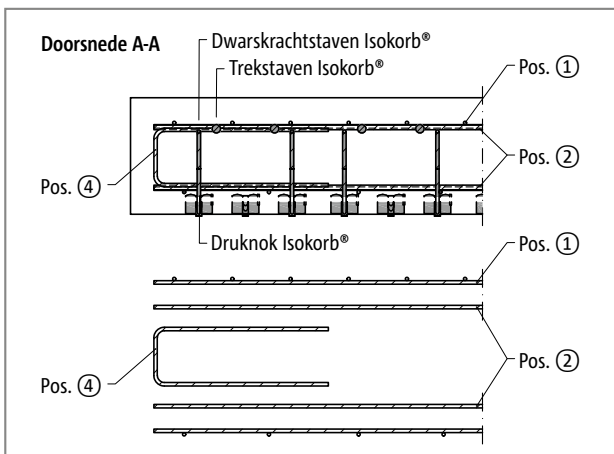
Schöck Isokorb® CXT type K-E: bijlegwapening; vloerplaatrand met opleg op wand
